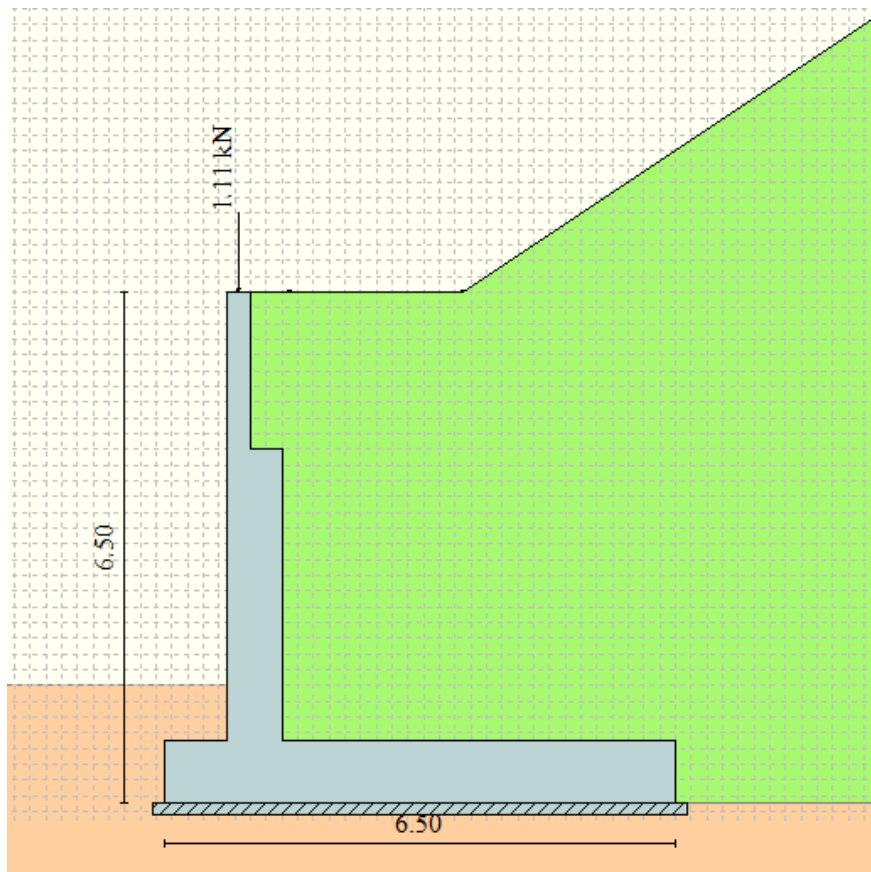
Applicazione dei carichi: Peso parapetto
